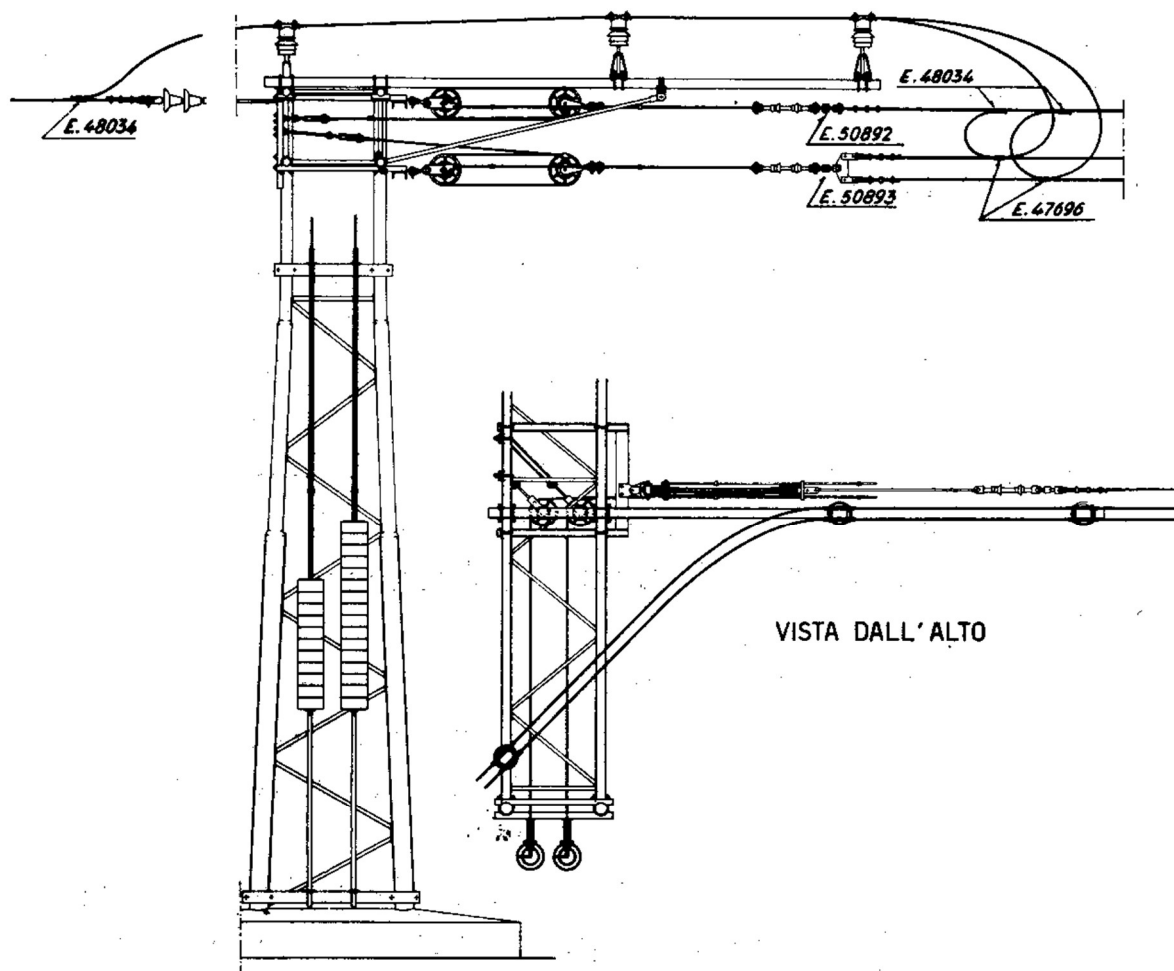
Disposizione delle apparecchiature nei portali di stazione
